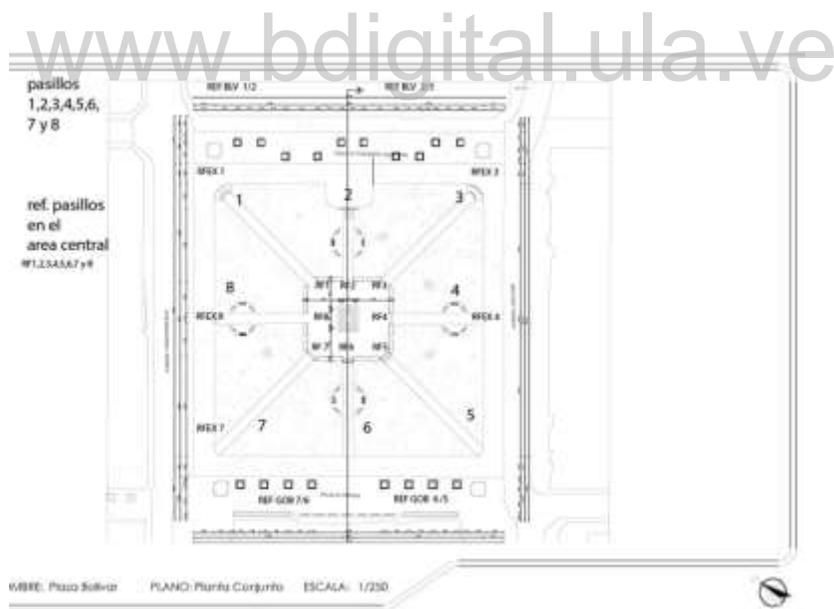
Nomenclatura espacial para elaboración de plan de rodaje del plano elaborado por el Arq. Adrián Navia Segovia.
